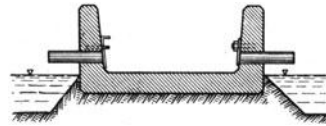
Verteilrinne aus Beton mit Rohrauslässen. (Nach Krüger.)
